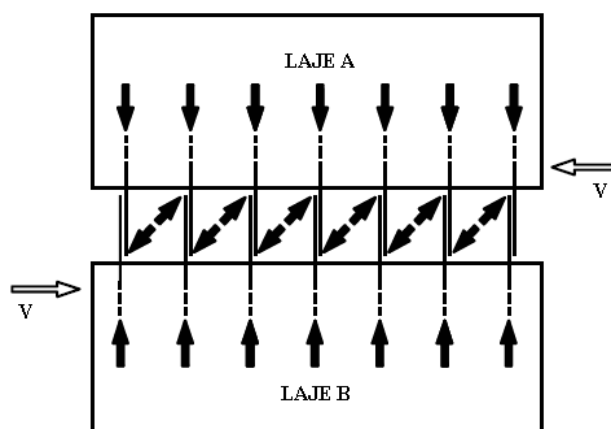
5 – Armadura distribuída ao longo do comprimento das lajes (BASEADO EM: FIB, 2008).
